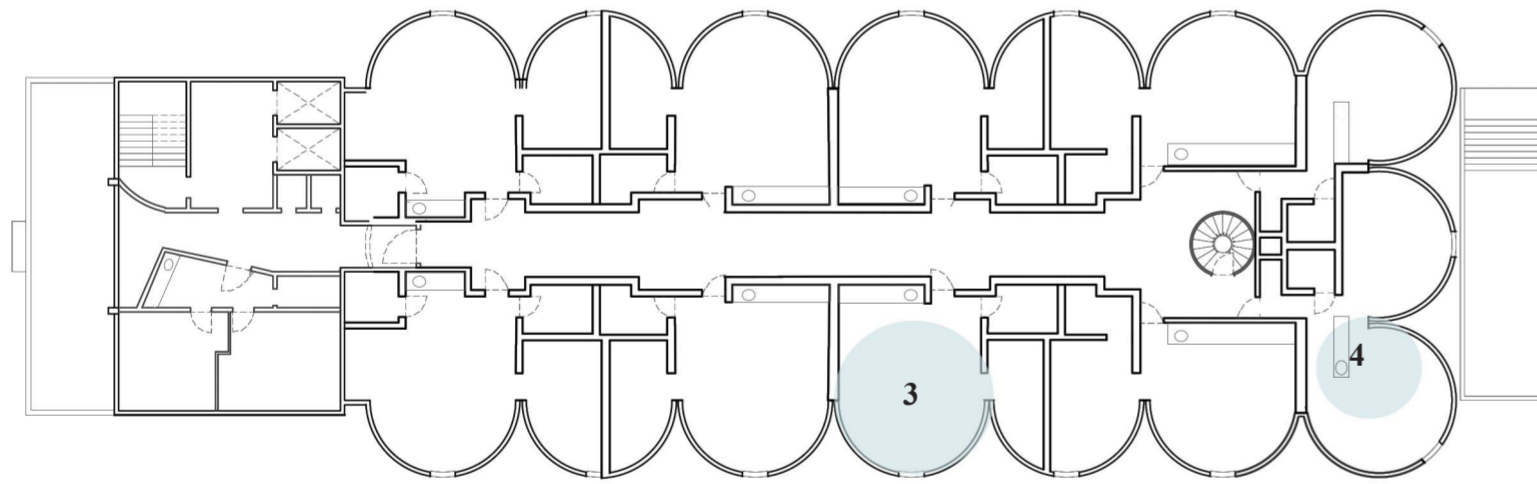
Planta habitaciones tipo 2 escala 1:400
